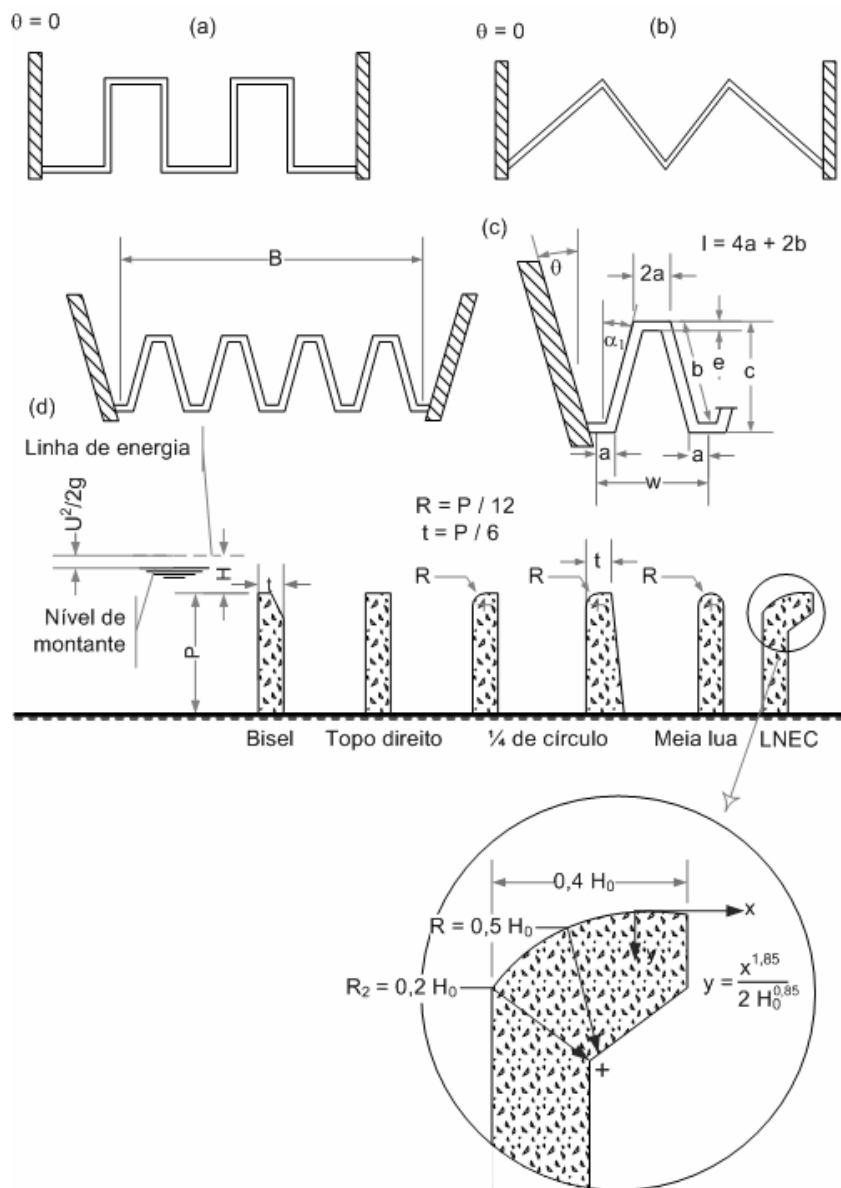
Esquema e formas em planta de soleiras em labirinto. Perfis transversais.
